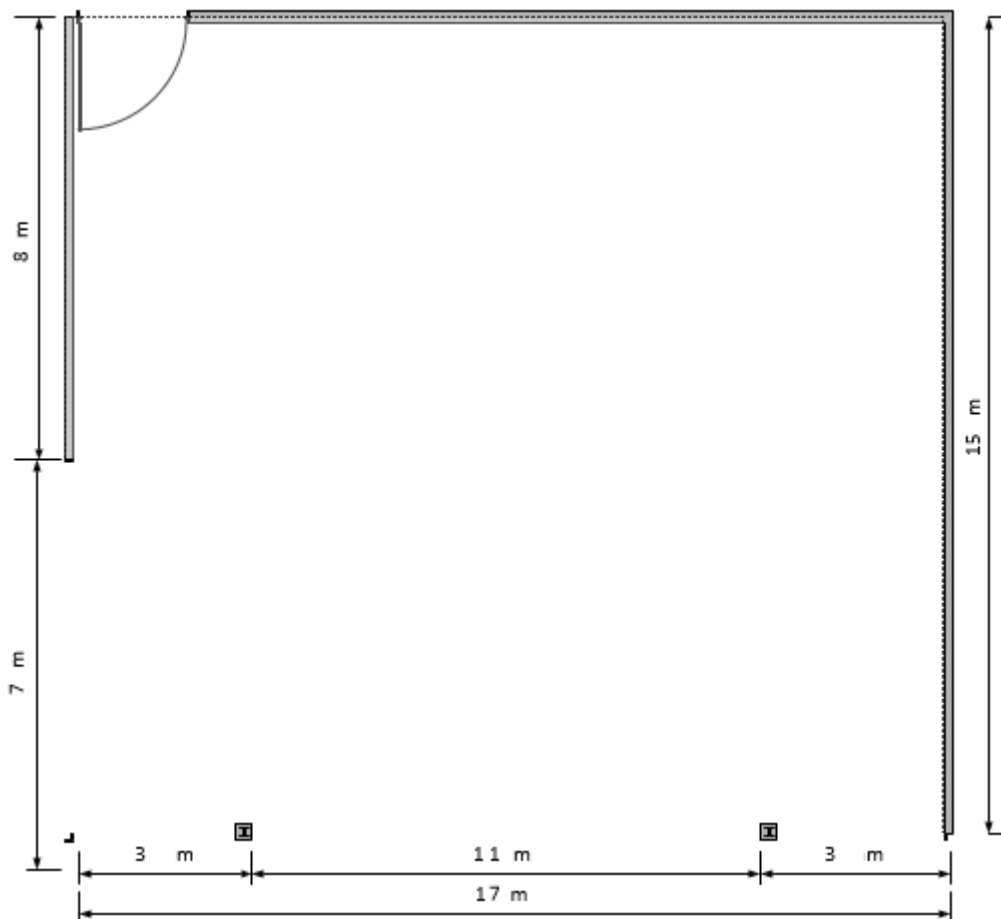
Planta do espaço disponibilizado para a construção da linha de montagem
